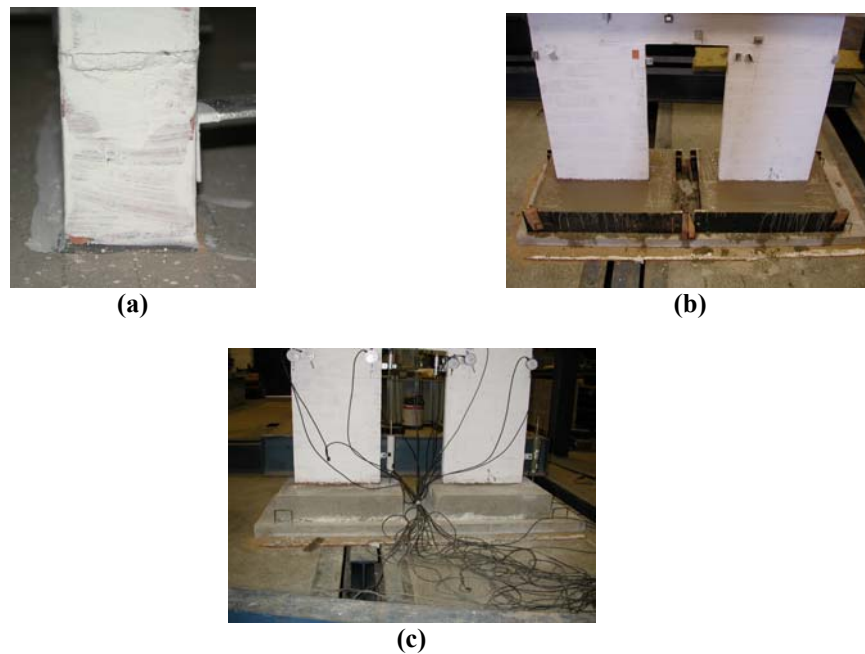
Preparação do ensaio do modelo PPSG1: (a) Detalhe da fissura no canto do painel após posicionamento; (b) Grauteamento recém realizado; (c) Detalhe das bases reforçadas e utilização de areia entre a laje de apoio e o fôrro.
